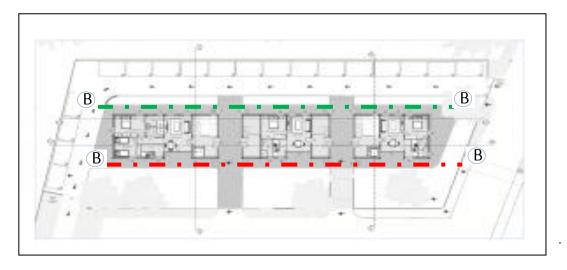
plan d'ensemble de bâtiment Trame d'ombra.
